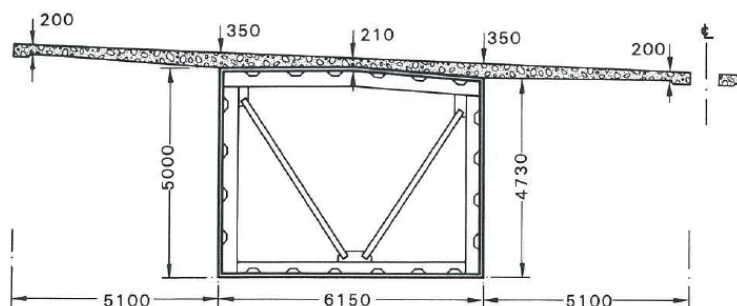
Secção transversal tipo da ponte Weiberswoog, Alemanha (Johnson, R.P. et al 1979).
